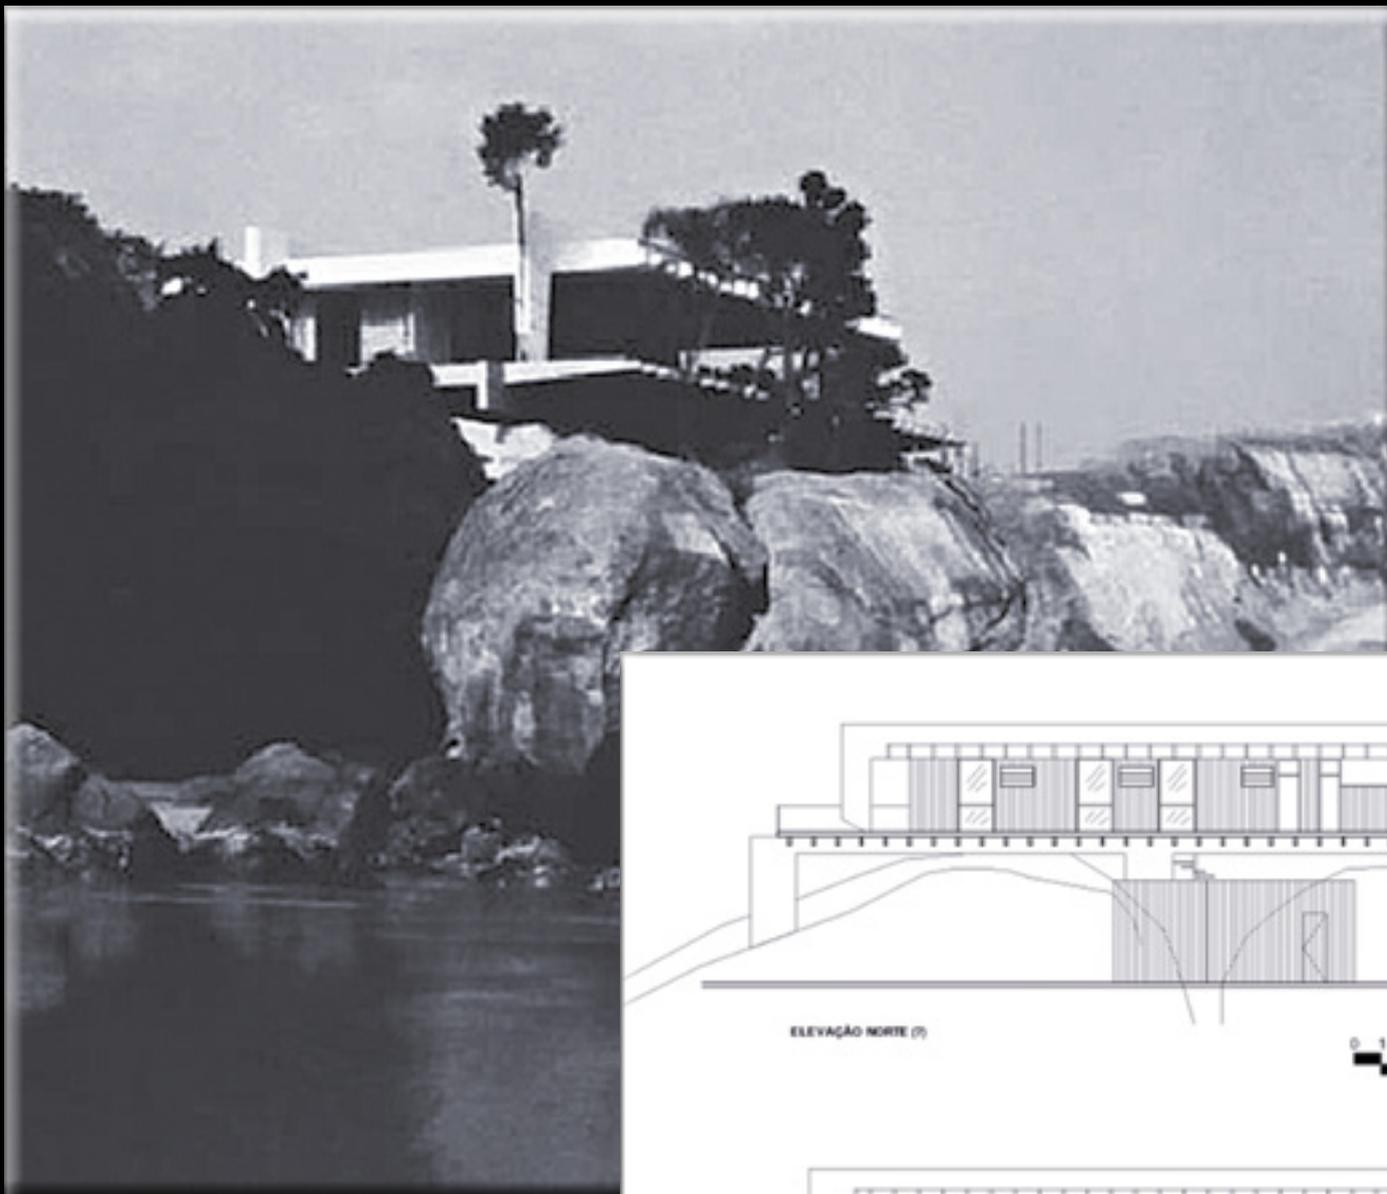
Vista exterior da casa sobre as rochas/ Vista do balanço lateral (fachada Oeste).
